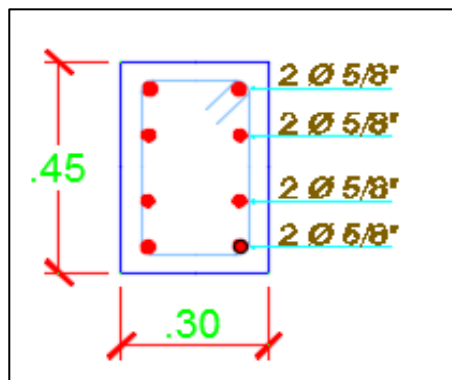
Sección Transversal Viga principal VP - 2. Fuente: Elaboración propia.
